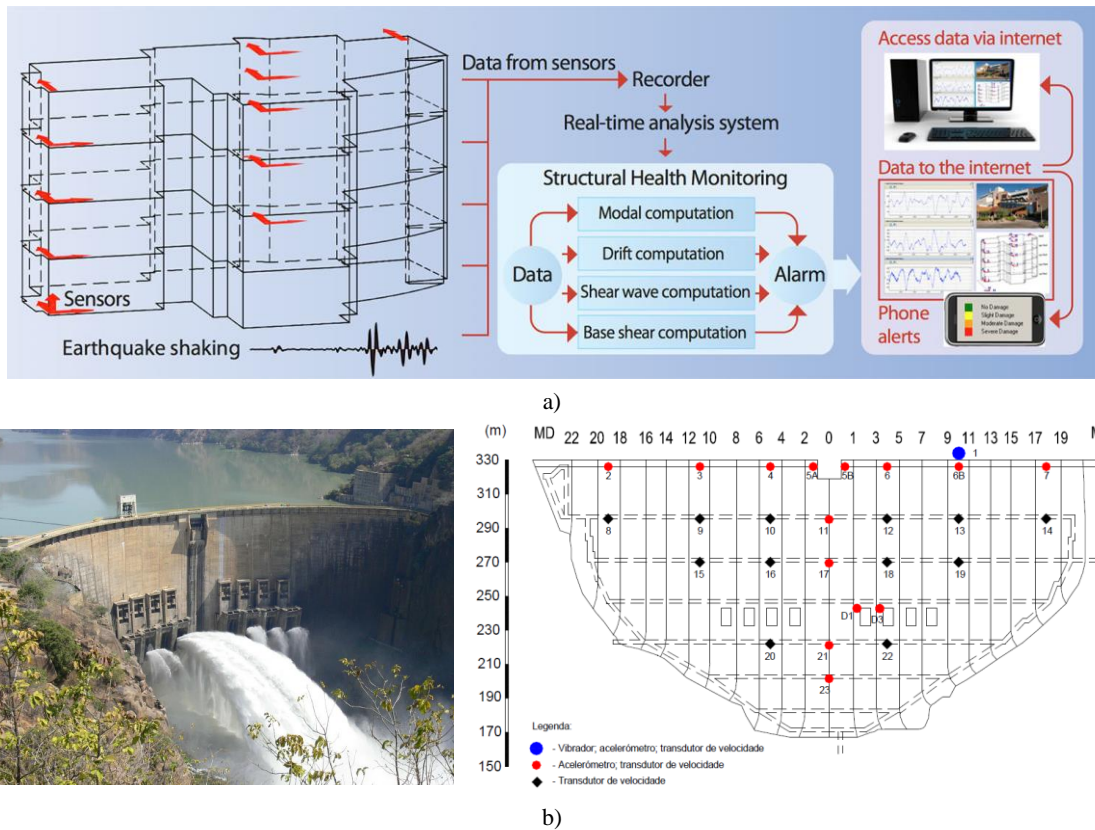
Monitorização permanente de estruturas de engenharia civil: a) edifício de betão armado (Doshi, 2014); b) barragens de betão armado (Gomes & Carvalho, 2014).
